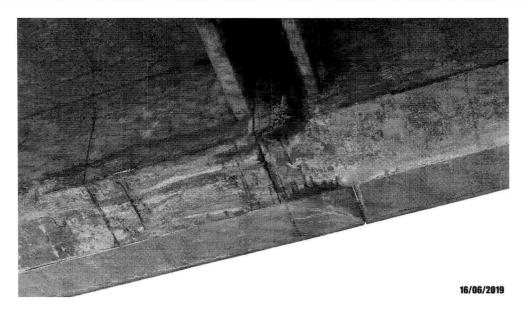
Detalhe da face inferior da viga com armadura exposta e infiltração na junta de dilatação.
